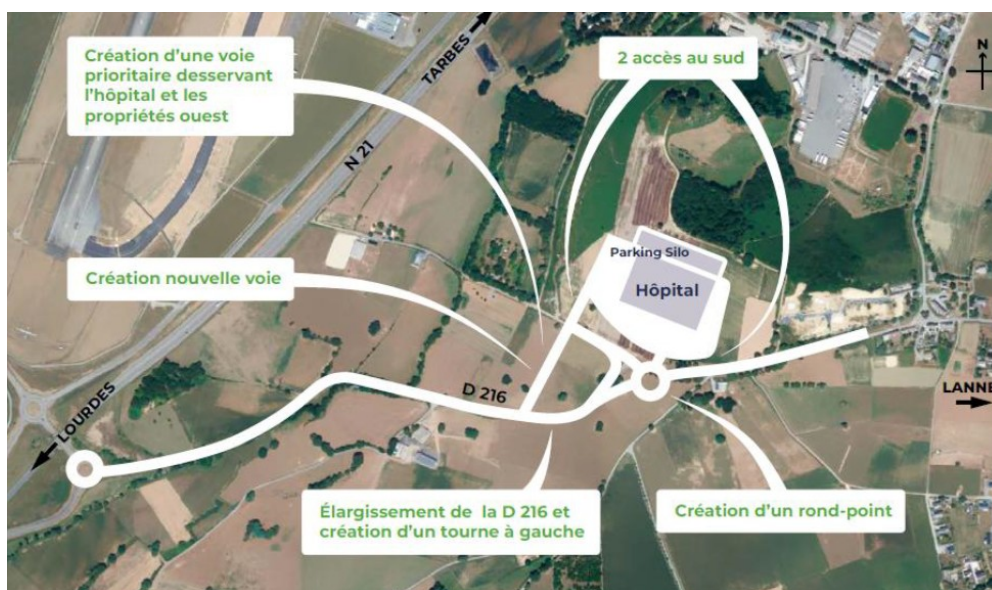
plan général des travaux routiers - extrait de l'étude d'impact
